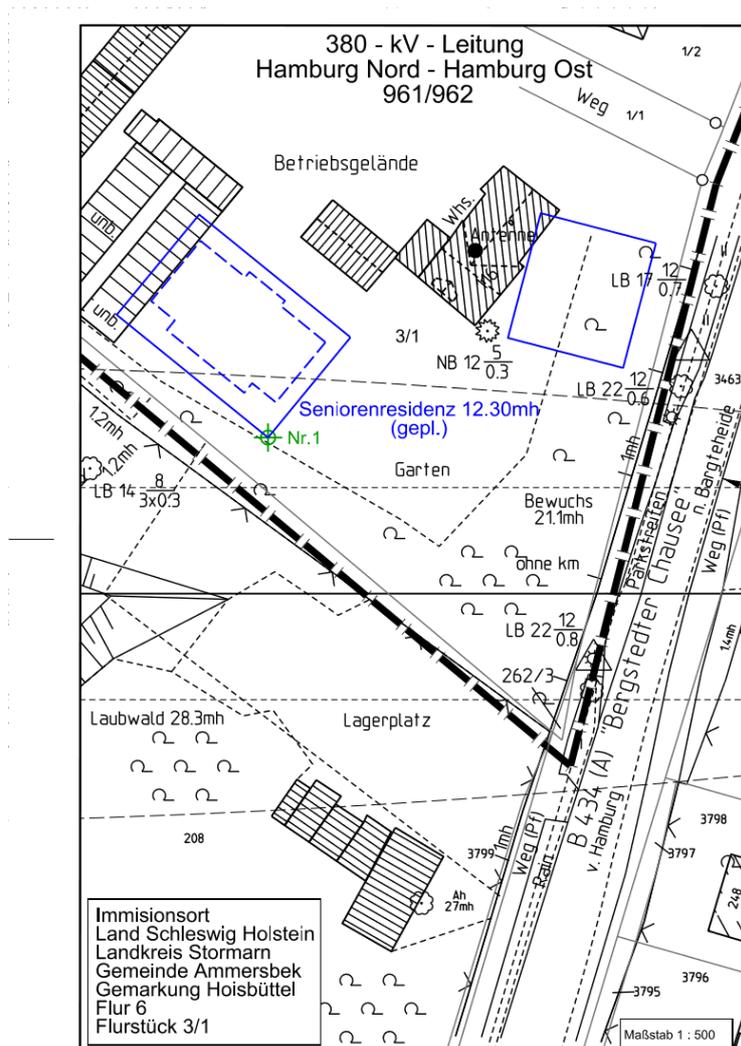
Lageplanausschnitt mit relevantem Immissionsort
